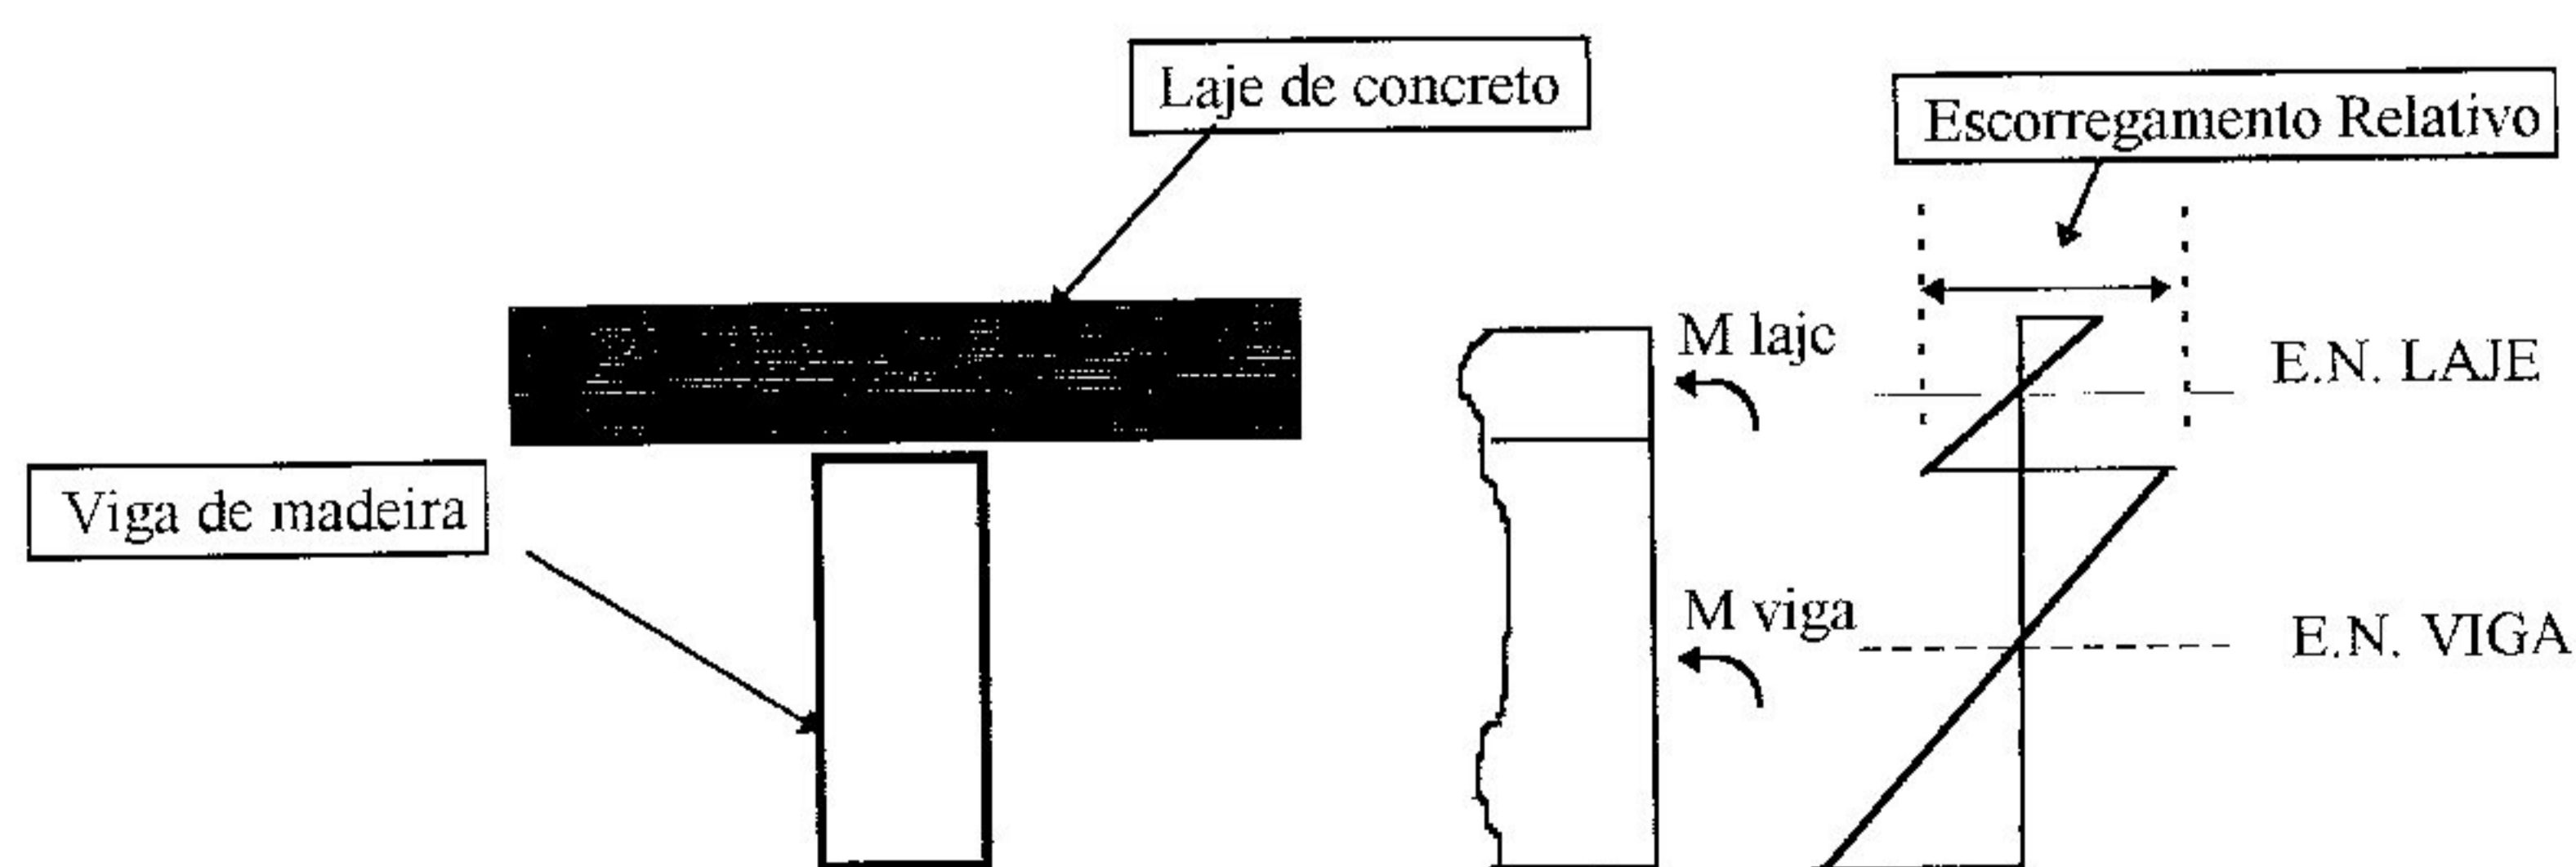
Distribuição de Deformações sem Interação entre a Viga de Madeira e a Laje de Concreto
